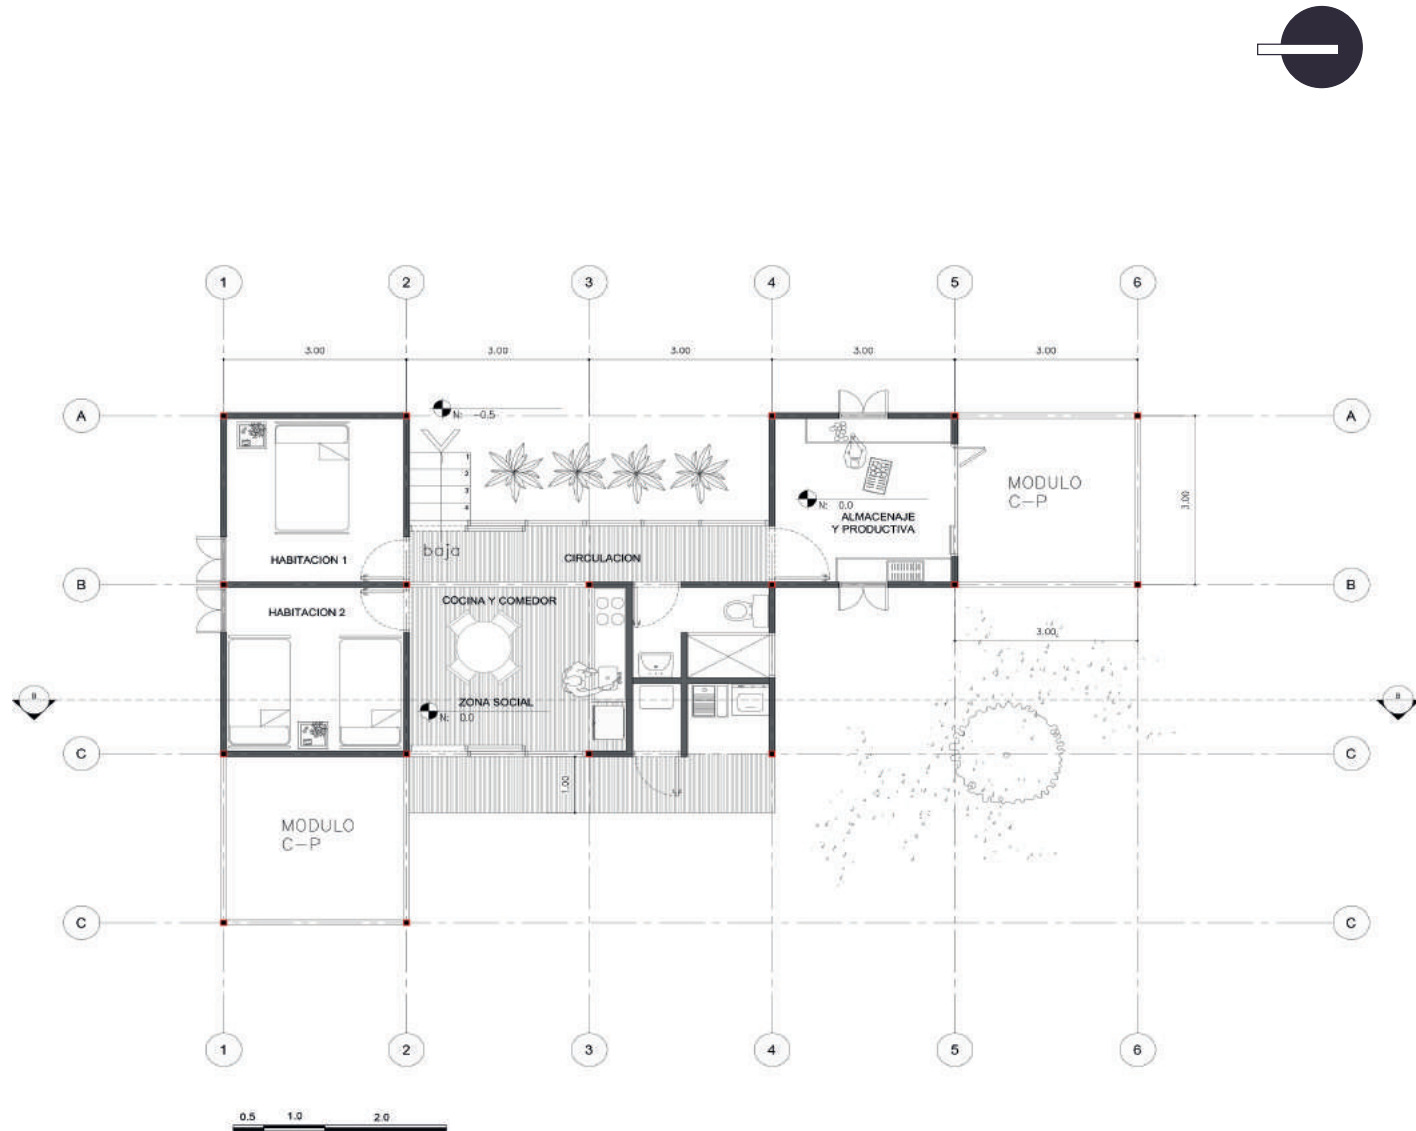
Planta arquitectónica alta montaña , Julián López, Juan Diego López, 2020.
